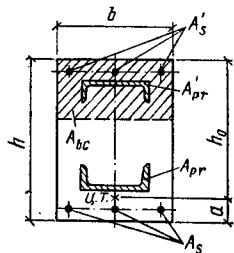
К расчету внецентренно сжатых элементов с жесткой арматурой; ветви размещены в растянутой и сжатой зонах
